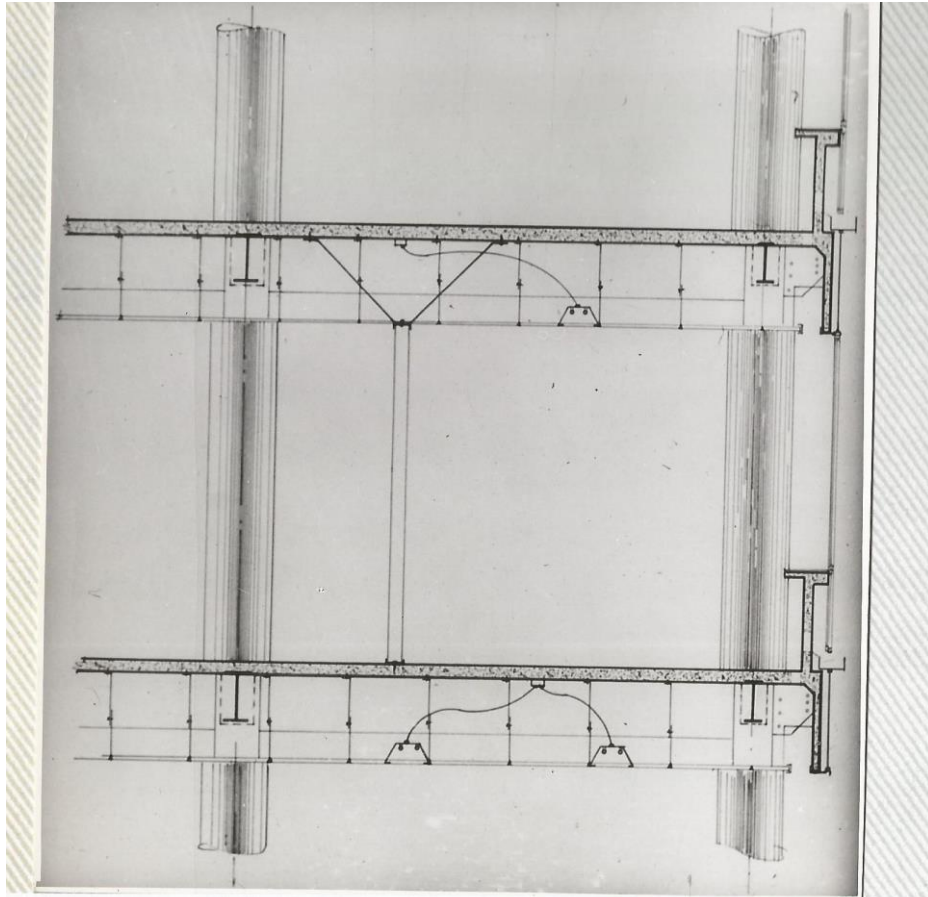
MUROS DIVISORIOS SEPARADOS DE LA ESTRUCTURA. (COLGADOS).
